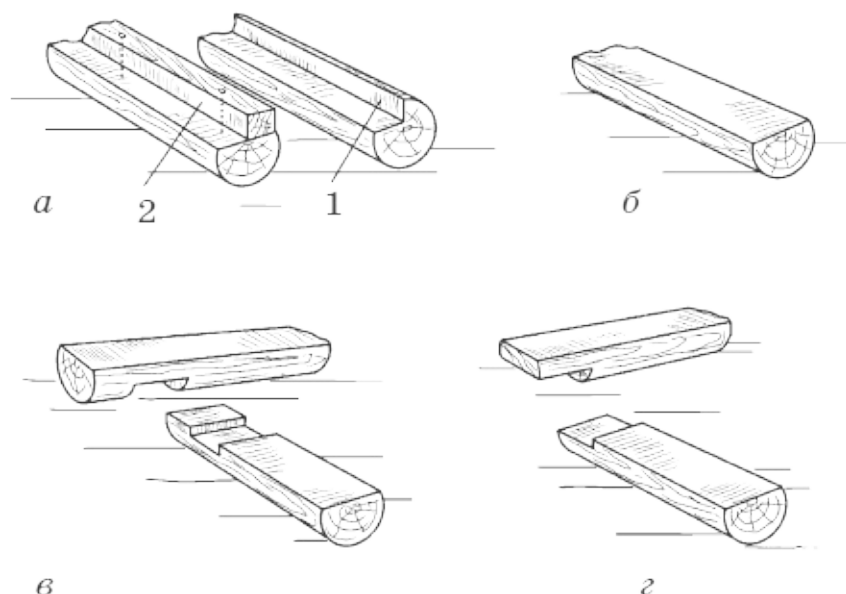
Устройство обвязки парника: а — южный парубень: 1 — вырубленный паз; 2 — рейка-упор для рам; б — северный парубень; в, г — соединение обвязочных бревен вполдерева
